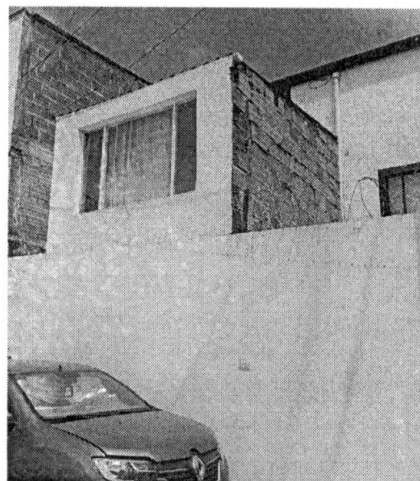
LADO POSTERIOR QUERELLADO 2
